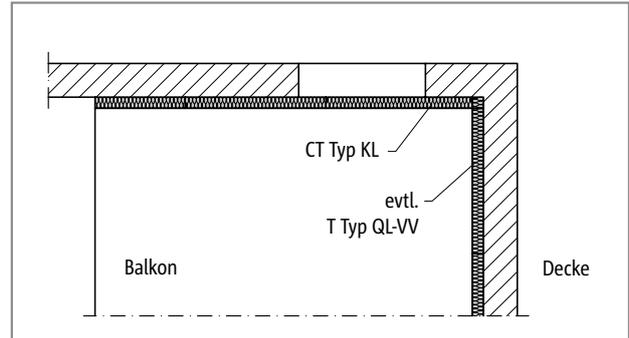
Schöck Isokorb® CT Typ KL, T Typ QL-VV: Balkon bei Inneneck, zwei-seitig aufliegend
